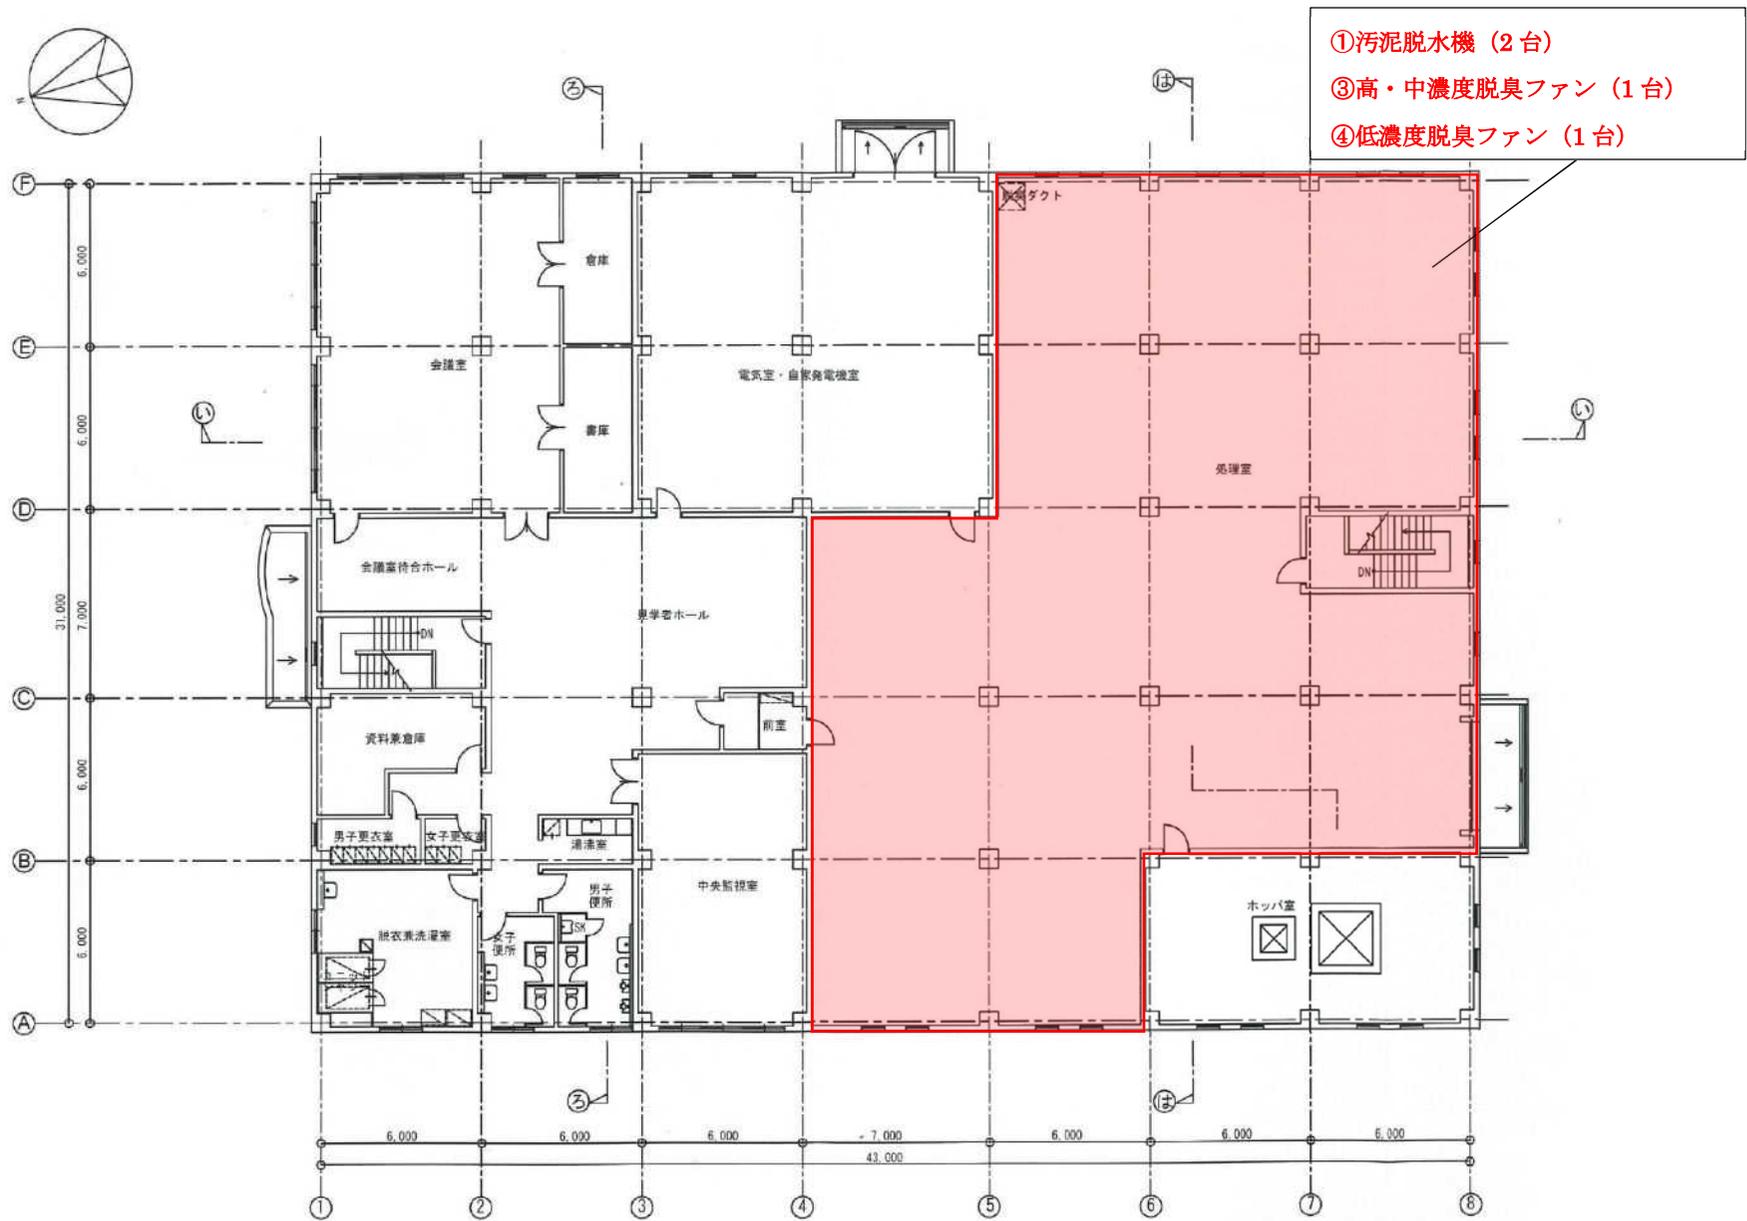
改修整備後の機器配置図 (2階平面図 (案))
